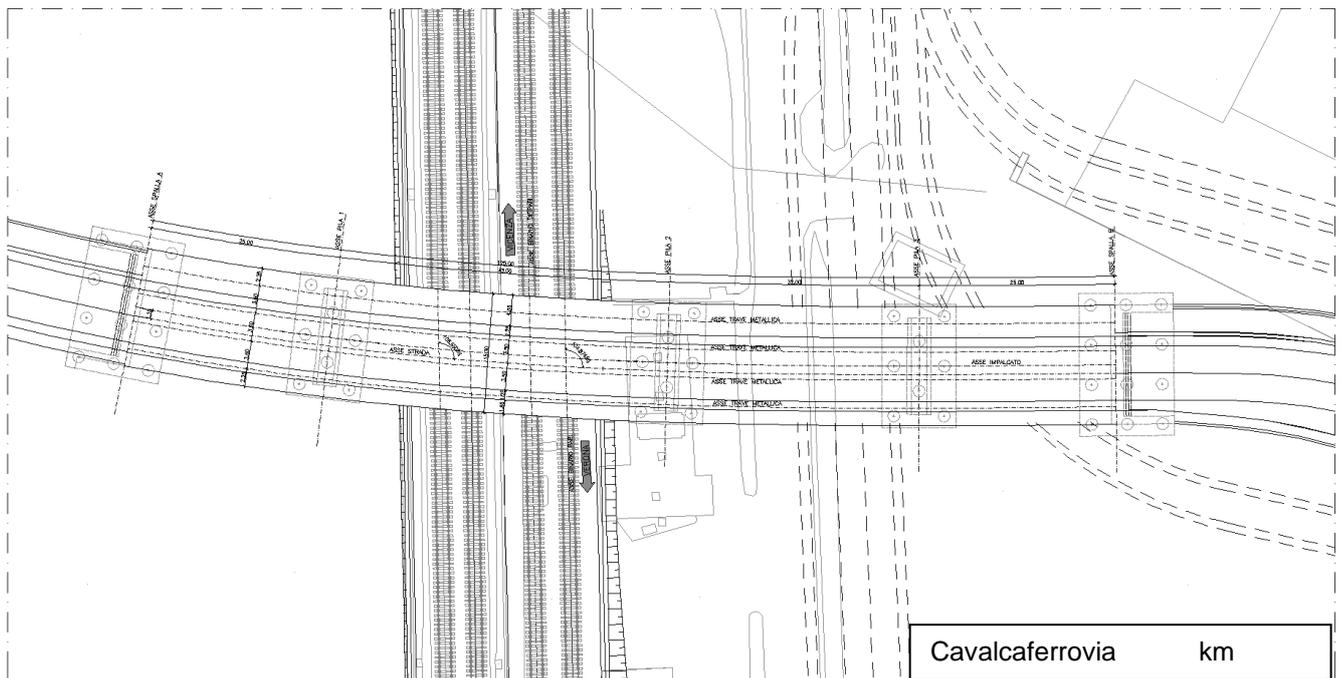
Stralcio planimetrico – ubicazione opera d'arte
